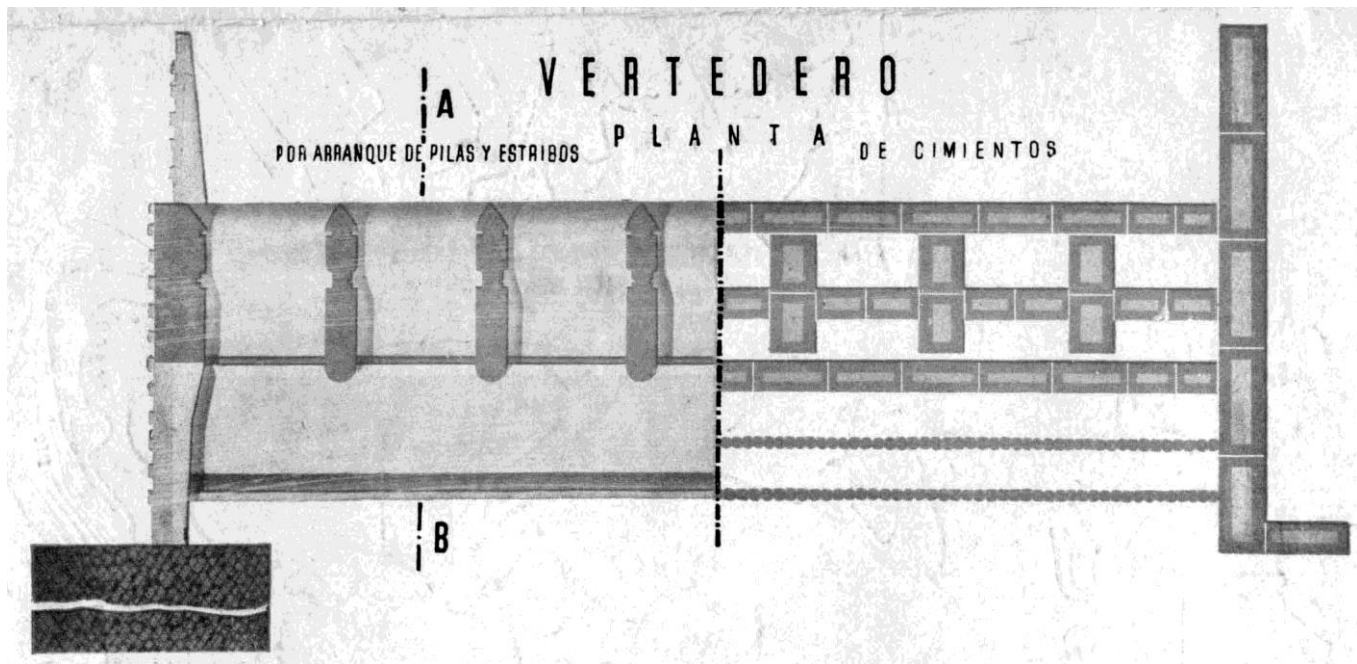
Croquis de la planta del vertedero de aguas de las compuertas de la presa y de su cimentación.
